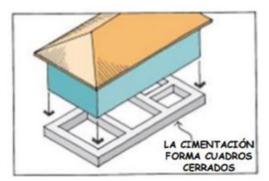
V. Baja. Cimentación. Chavarría y Gómez (2001)
